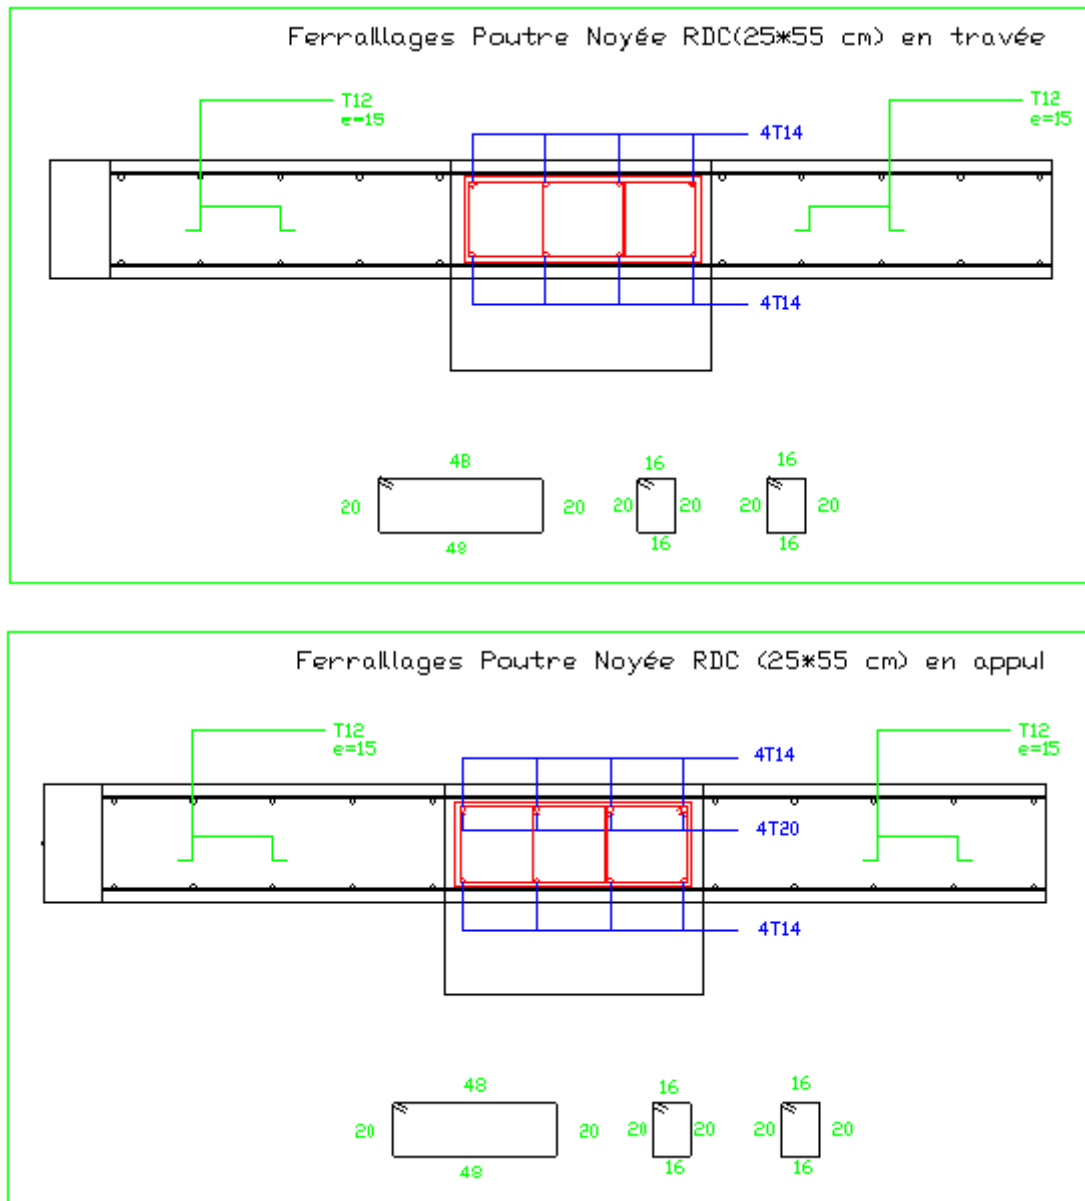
Ferrailage poutre noyé (25*55) appui et travée RDC
